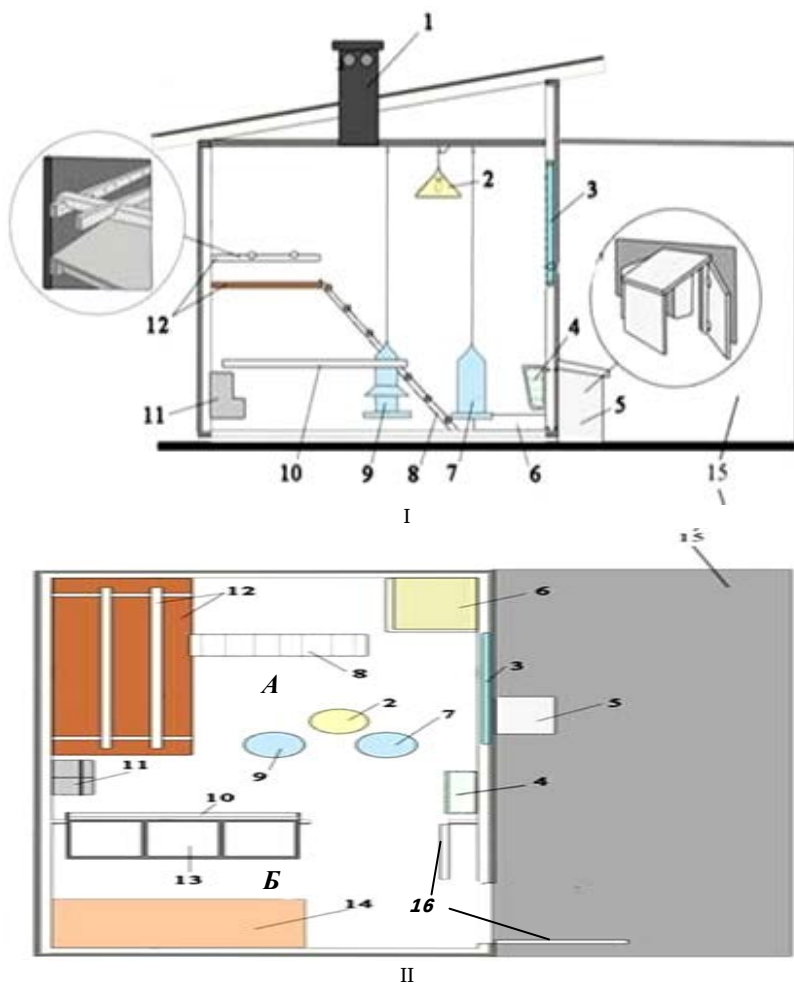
План курятника: I – продольный разрез, II – поперечный разрез;
